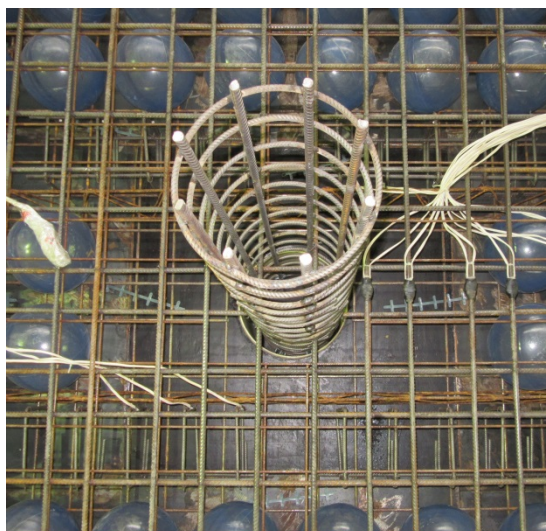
Foto da armadura do pilar posicionada na laje
